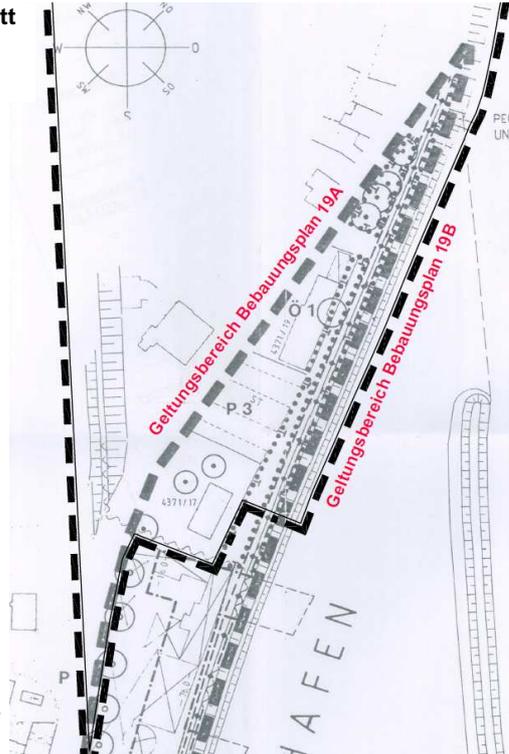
(rechts): Ausschnitt Bebauungsplan 19A „Im Sterngarten Teilbebauungsplan Alter Hafen“
